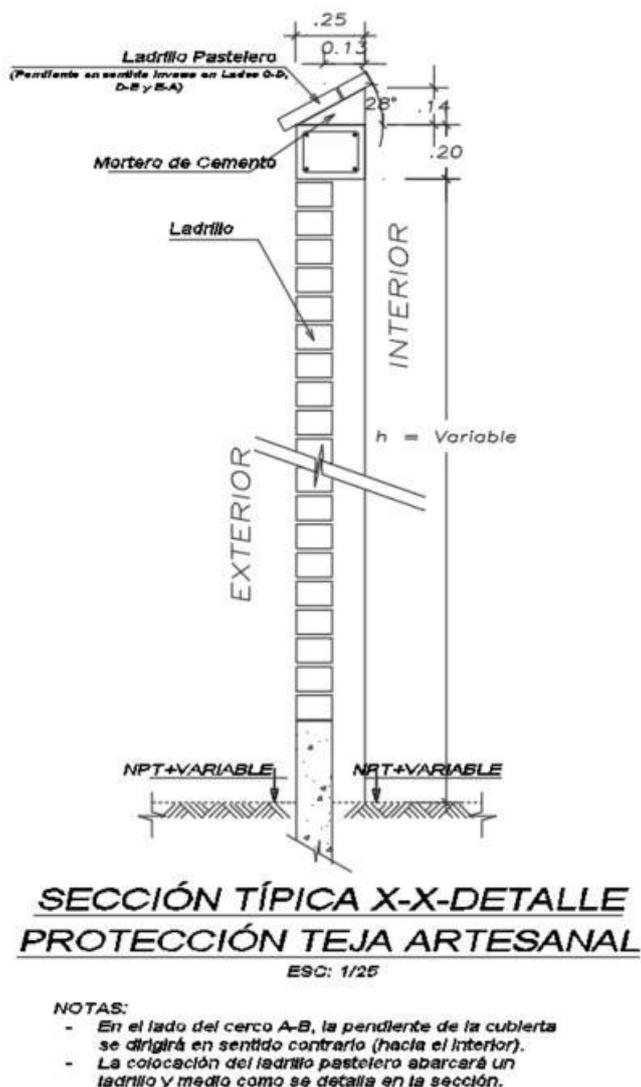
Sección típica X-X-detalle protección teja artesanal del plano A-
